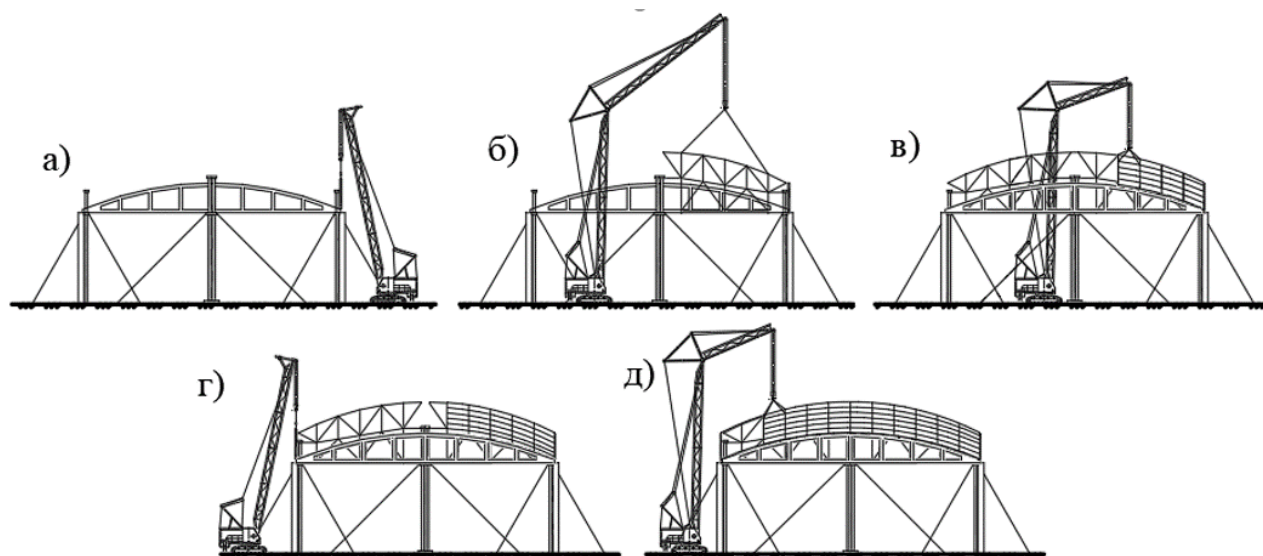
Монтаж железобетонных оболочек двойной положительной гауссовой кривизны с применением пространственных блочных лесов: а – монтаж трёх контурных фермы; б – установка трех блоков пространственных лесов; в – монтаж плит покрытия; г – монтаж четвёртого блока лесов и установка фермы; д – монтаж плит покрытия последней четверти
